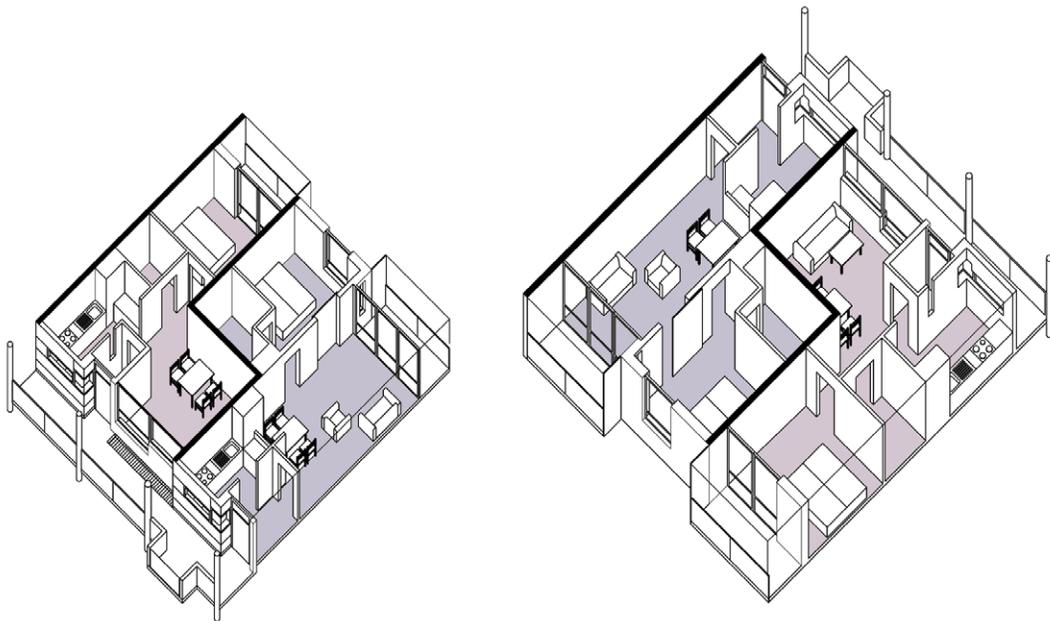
/ Plano plantas 3-5, viviendas para ancianos en violeta.
